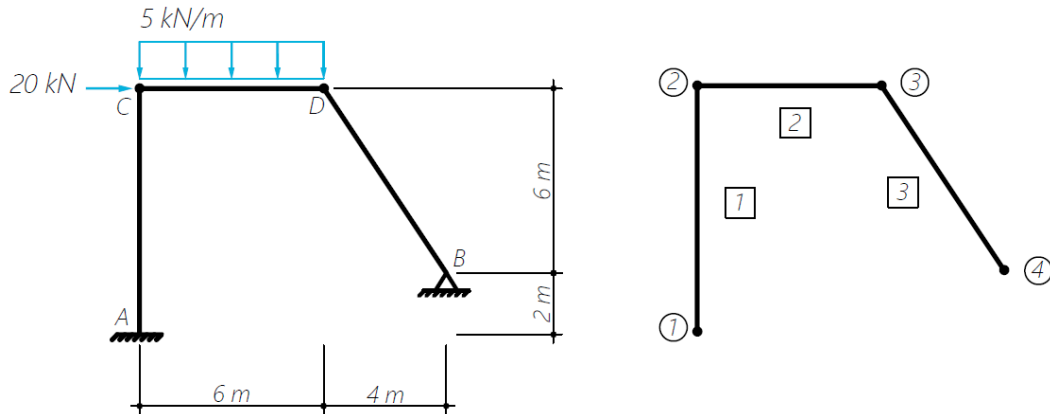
Modelo de pórtico plano estudado. Adaptado de Martha (2010).
